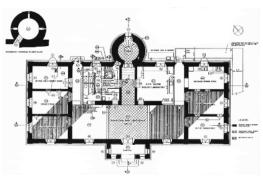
Planta del proyecto de restauración. (del Cueto, 1988)
